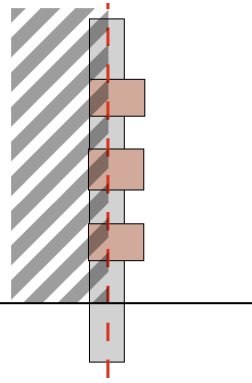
Schéma d'un mur mitoyen avec la disposition de harpes d'attentes de mitoyenneté en façade
